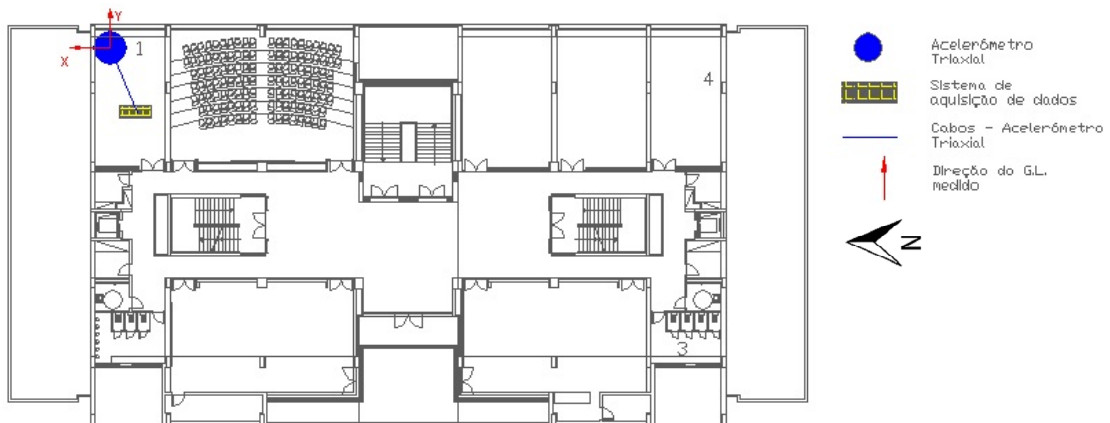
Esquema com a posição do equipamento de medição para o primeiro ensaio.
